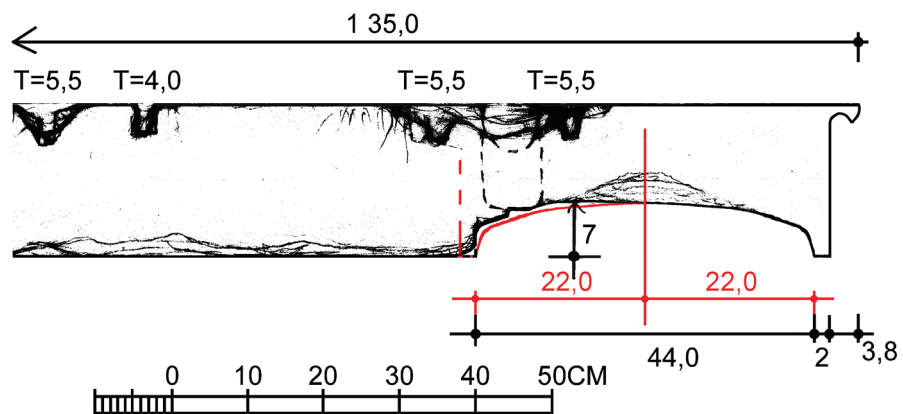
Trapezá Aigiou, Detail des Profils an der Soffitte des Schräggeisons (SGB 1) (M. 1 : 10)
